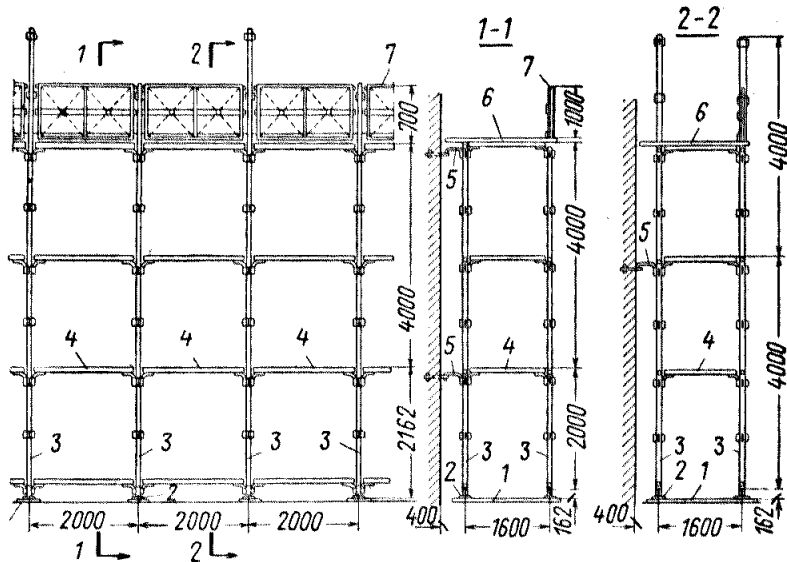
Безболтовые трубчатые леса (фасад и разрезы)
